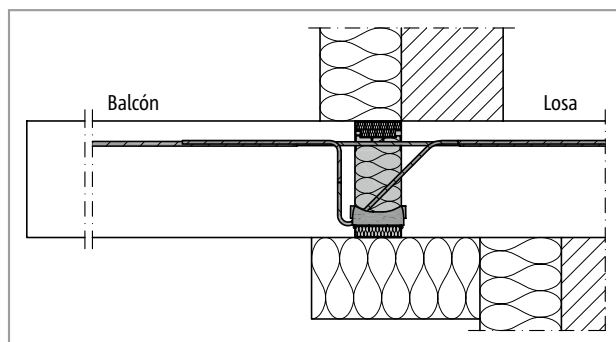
Schöck Isokorb® T tipo K: Conexión para losa apoyada indirectamente y SATE
